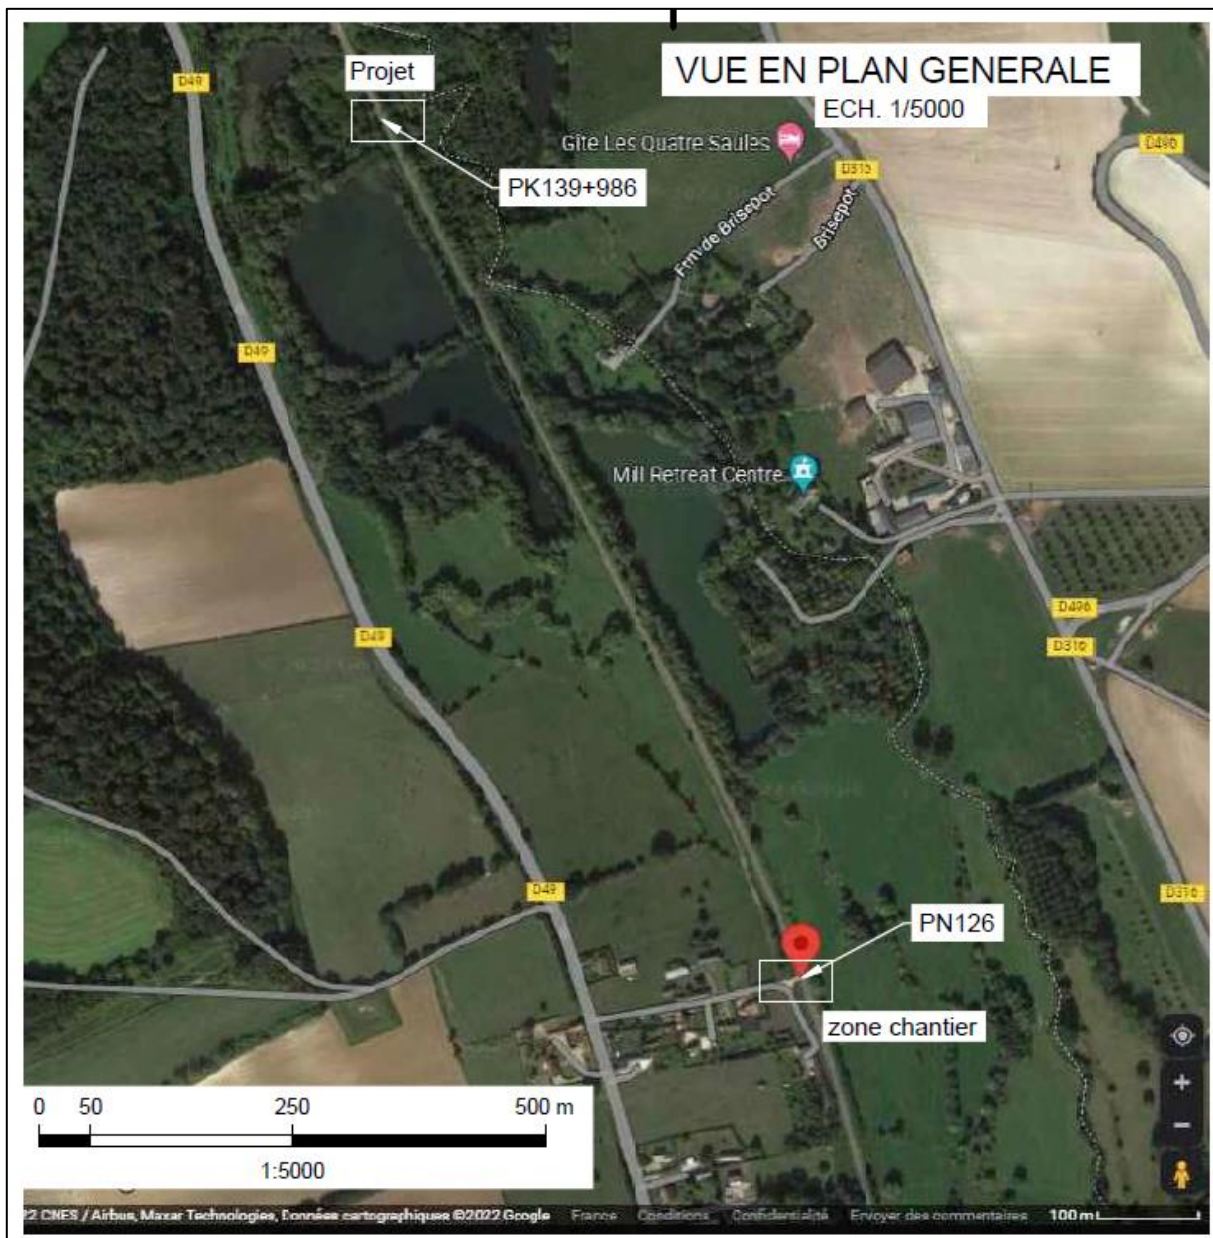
Ligne 325 000 – Dispositions générales du chantier – Accès entre la base-travaux au PN 126 (Commune d'Aumale) et le Pont-Rail au Pk 139+986 le long de la voie ferrée.
